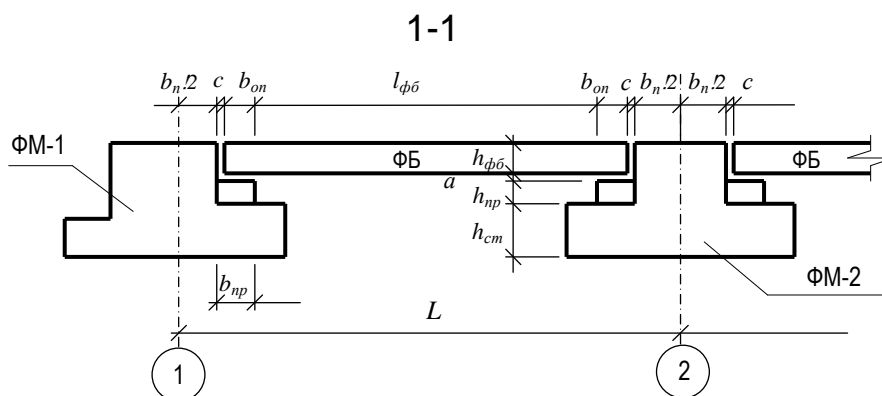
Конструирование расположения фундаментных балок: а – в плане;
